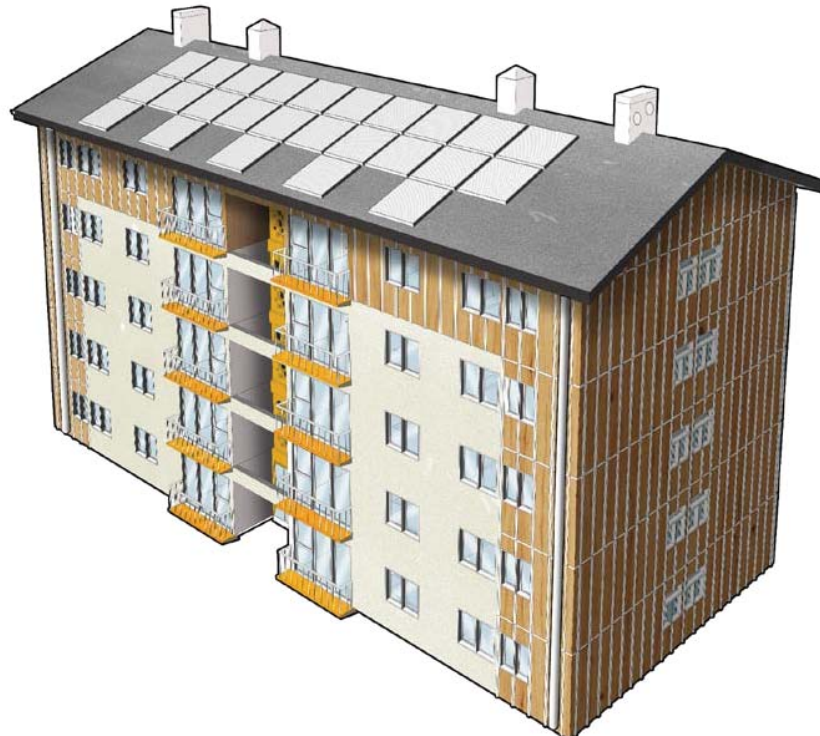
Vista exterior del modelo mejorado. Fuente: Álvaro Aedo.
